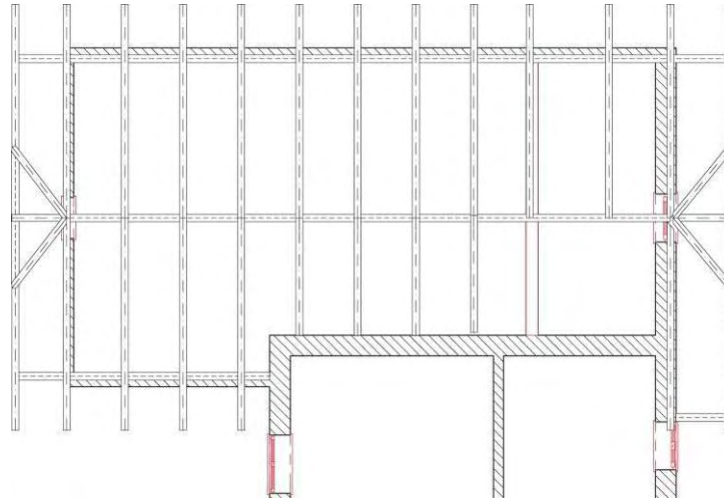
Sparrenplan Dachfläche Nebentrakt (Darstellung nicht genordet)
